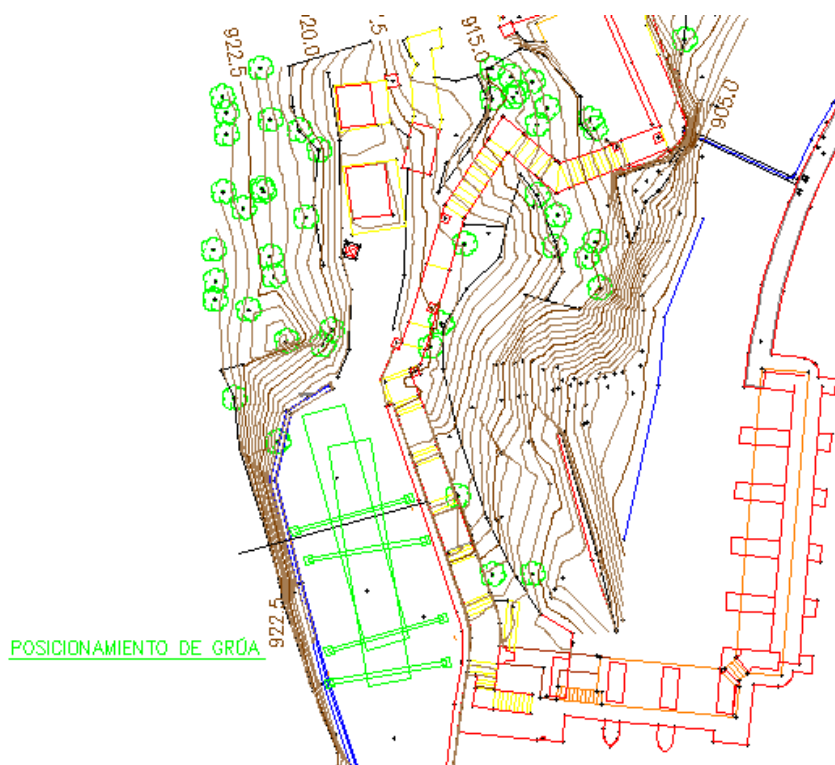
Posicionamiento de la grúa 300 t en la plataforma existente
